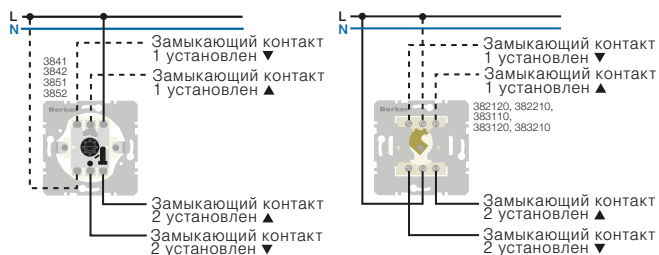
Поворотный выключатель жалюзи 1- и 2-полюсный [№ для заказа 3841, 3842]; выключатель жалюзи 1- и 2-полюсный для центральной панели с замком [№ для заказа 3851, 3852]/выключатель/кнопка жалюзи 1- и 2-полюсный для профильных полуцилиндров [№ для заказа 382..., 383..]
